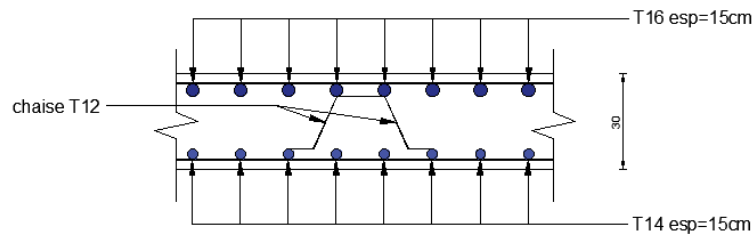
Schéma de ferrailage de la dalle du radier sur travée sens x-x.
